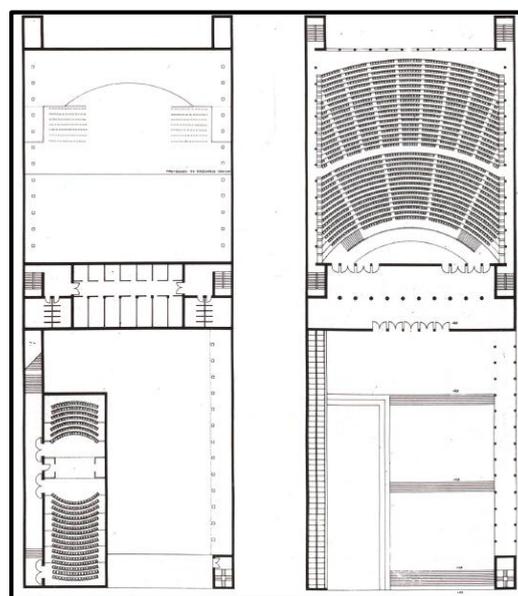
Vues en plan sur les 2 niveaux de la salle Argenta et la salle Pereda
